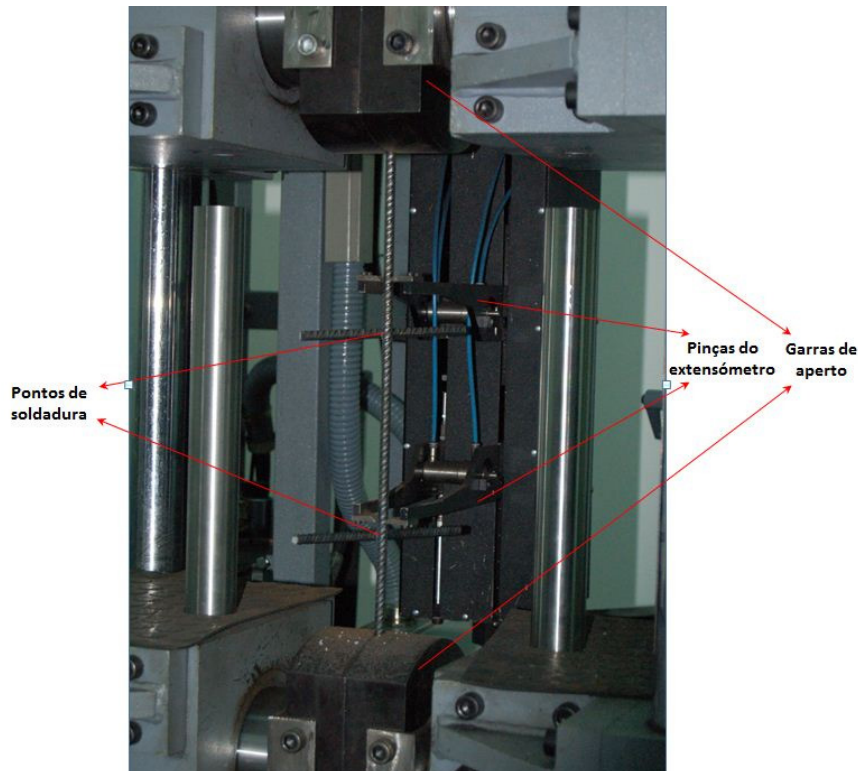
Provete tipo 2 colocado na máquina de ensaios de tracção
